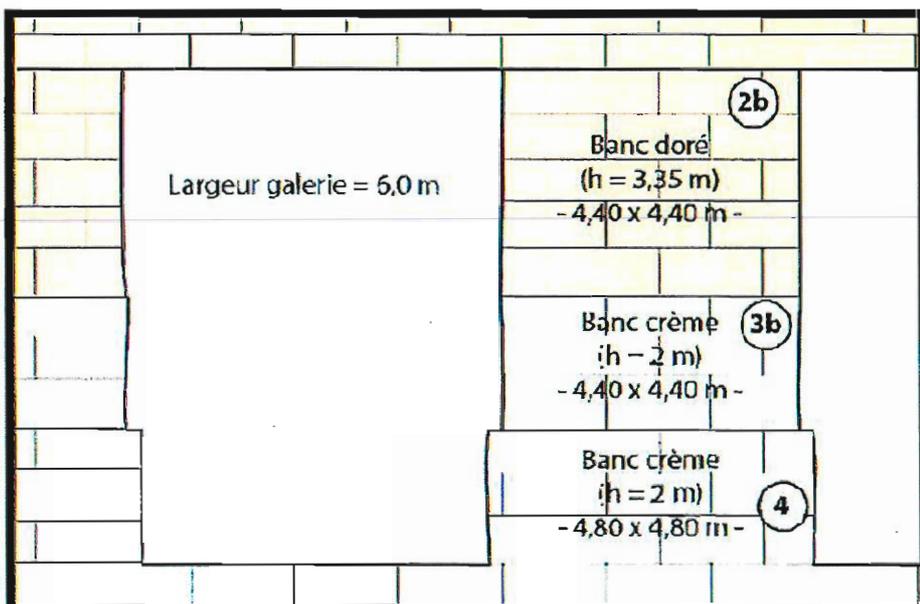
Dimensionnement des galeries et piliers des zones A, B, C, D, E, F et G
